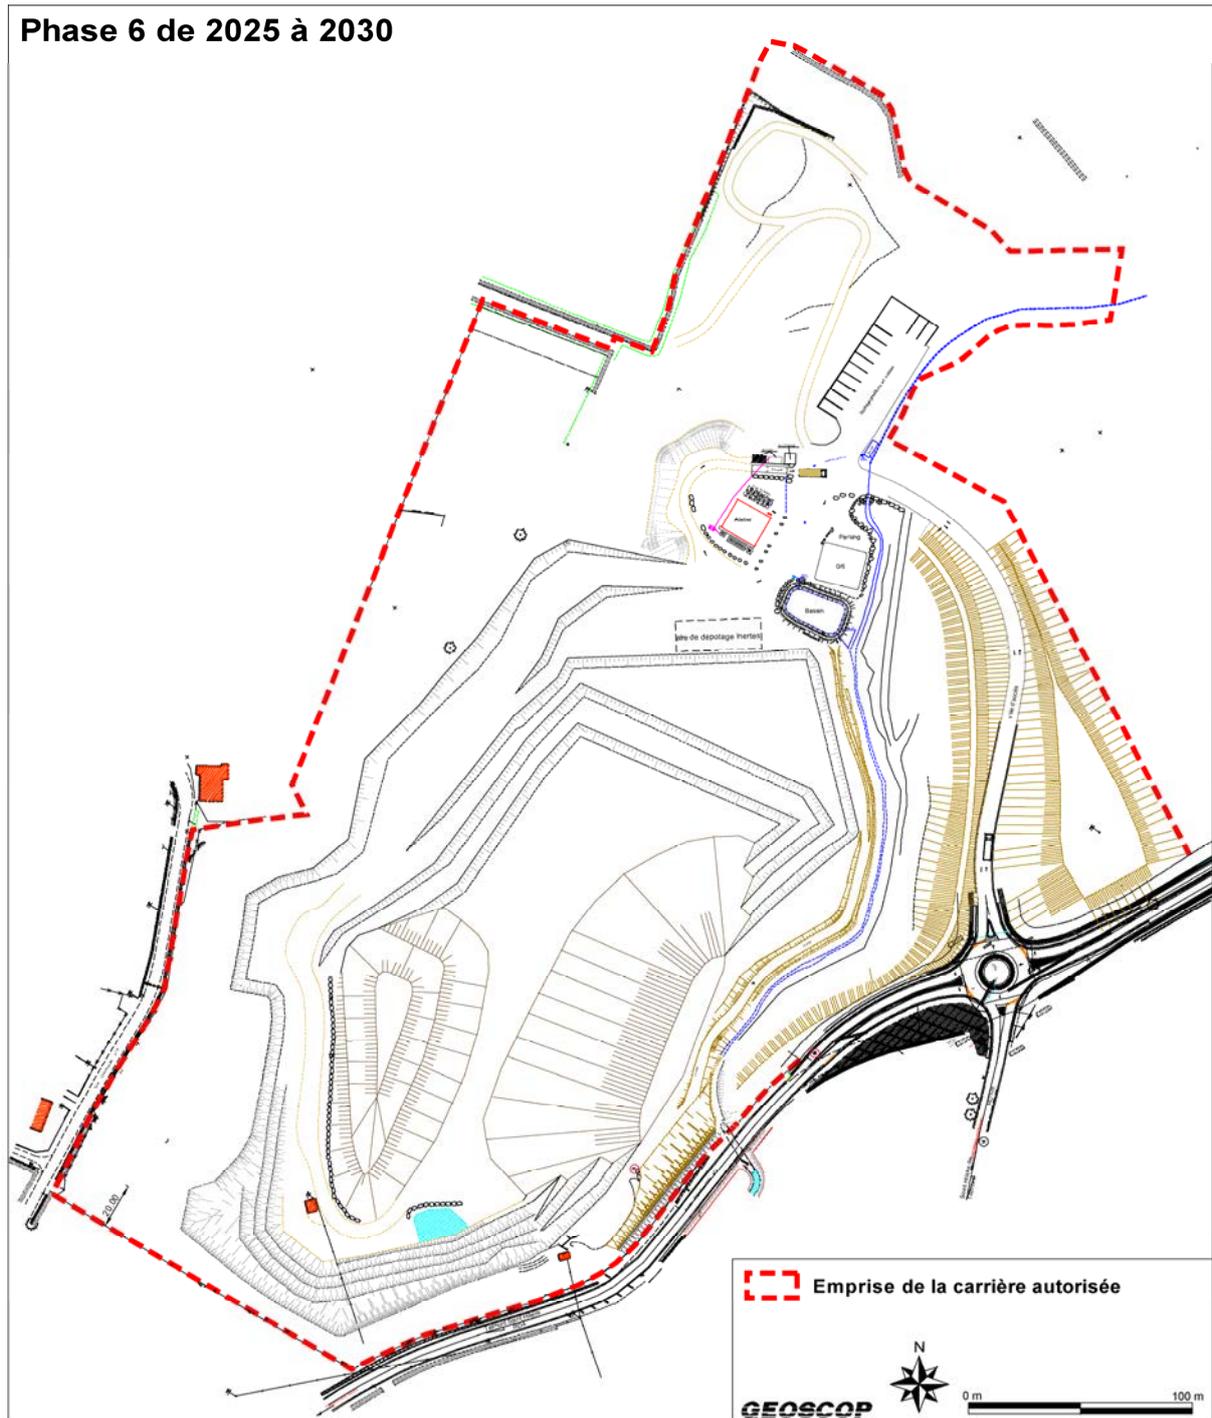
Vue de la carrière en 2030 avant remontée des eaux.
